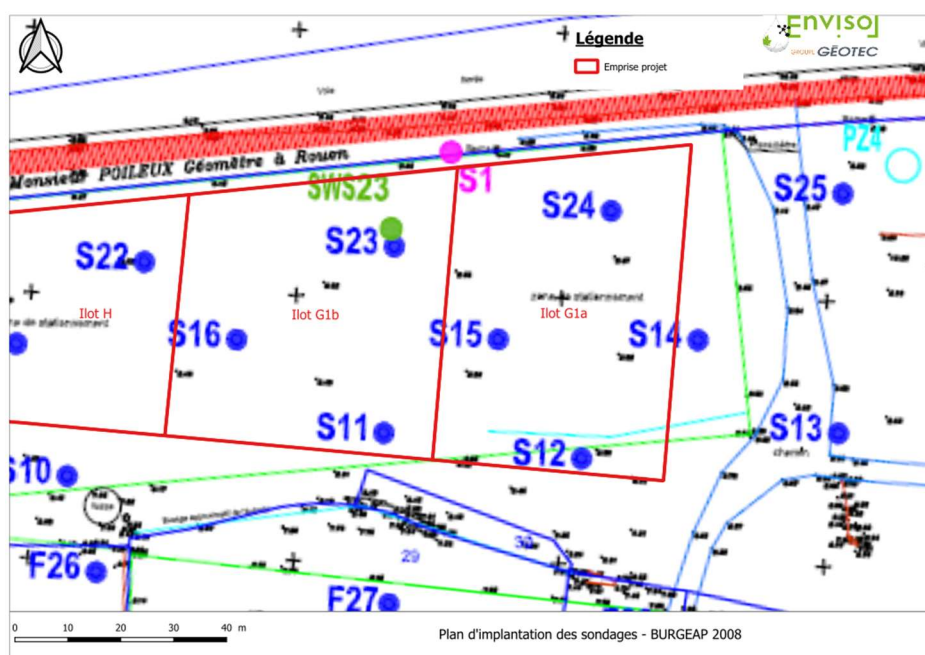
Plan d'implantation des sondages (source BURGEAP, 2008)
